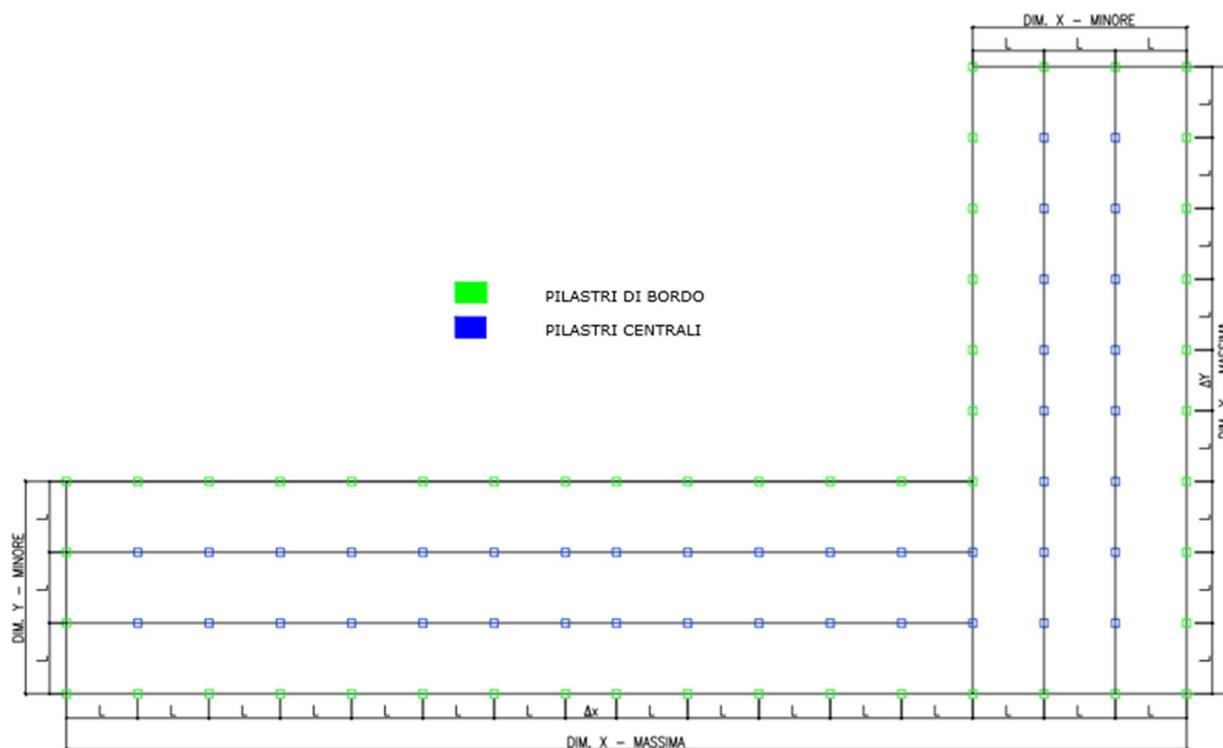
Pianta piano tipo del modello speditivo aggiornato
